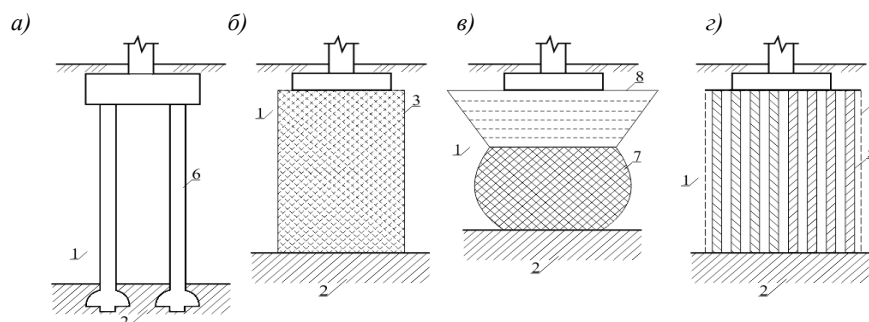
Різні варіанти влаштування основ і фундаментів в ґрунтових умовах при II типі просідання: а – прорізка просідаючої товщі палями різного типу або глибокими фундаментами; б – закріплення ґрунтів хімічними або термічними способами; в – ущільнення ґрунтів попереднім замочуванням в поєднанні з глибинними вибухами і ущільнення важкими трамбівками; з – ущільнення ґрунтів ґрунтовими палями; 1 – просідаючий ґрунт; 2 – непросідаючий ґрунт; 3 – закріплений ґрунт; 4 – зона ущільнення ґрунтовими палями; 5 – ґрунтові палі; 6 – палі; 7 – ущільнений ґрунт; 8 – ґрунт, ущільнений важкими трамбівками
